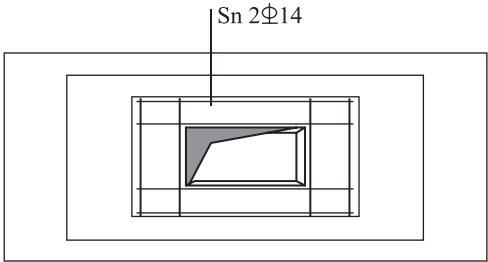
单杯口独立基础顶部焊接钢筋网示意图
